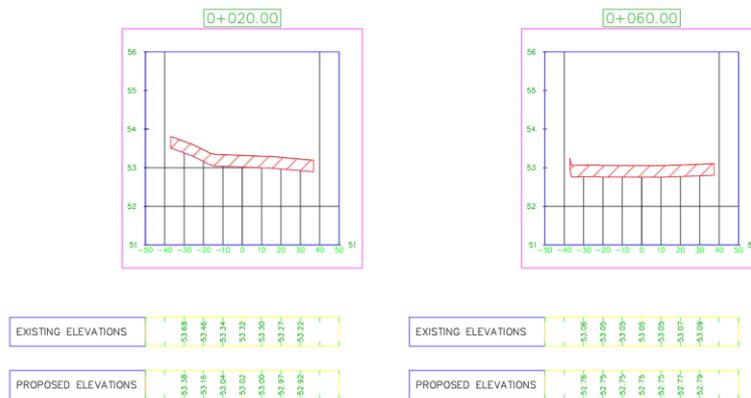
Profil Tanah Eksisting dan Profil Tanah Stripping
